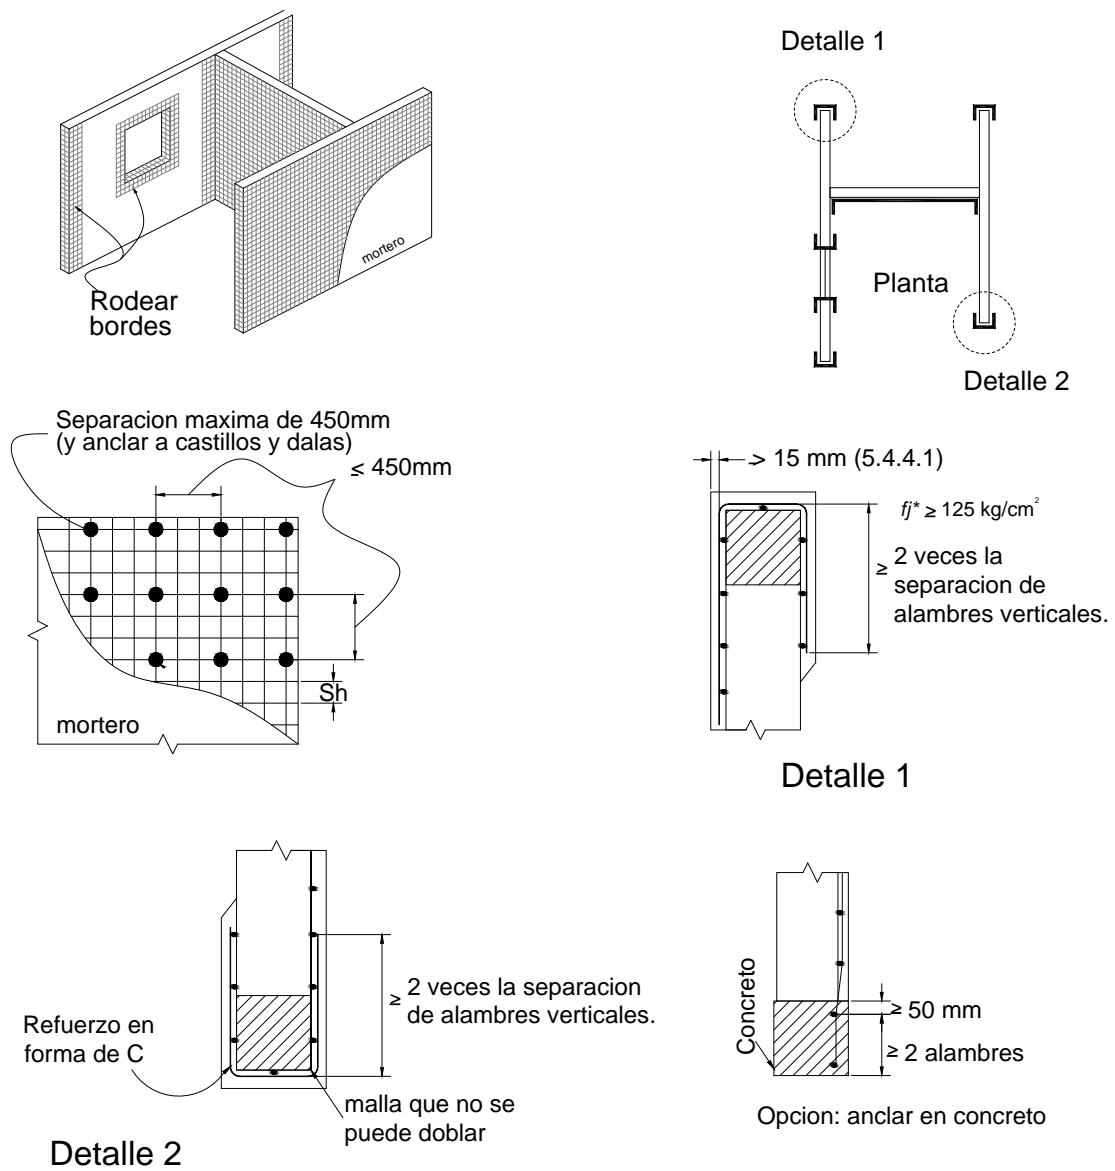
Refuerzo con malla de alambre soldado y recubrimiento de mortero
